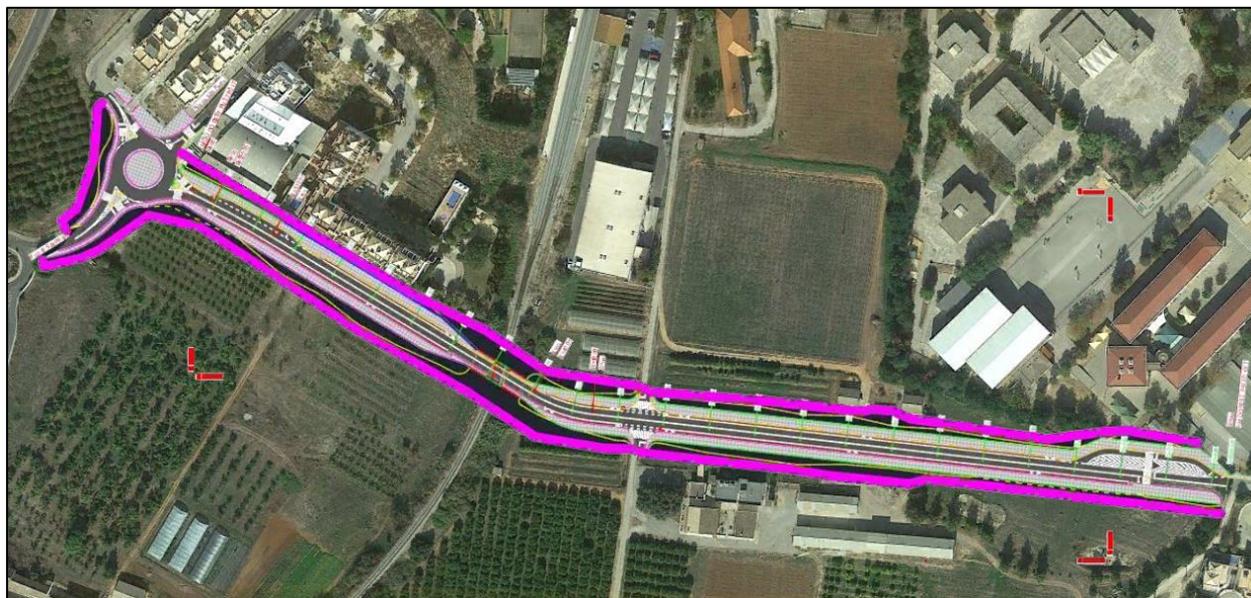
Planta de implantação do restabelecimento da PN371+317
